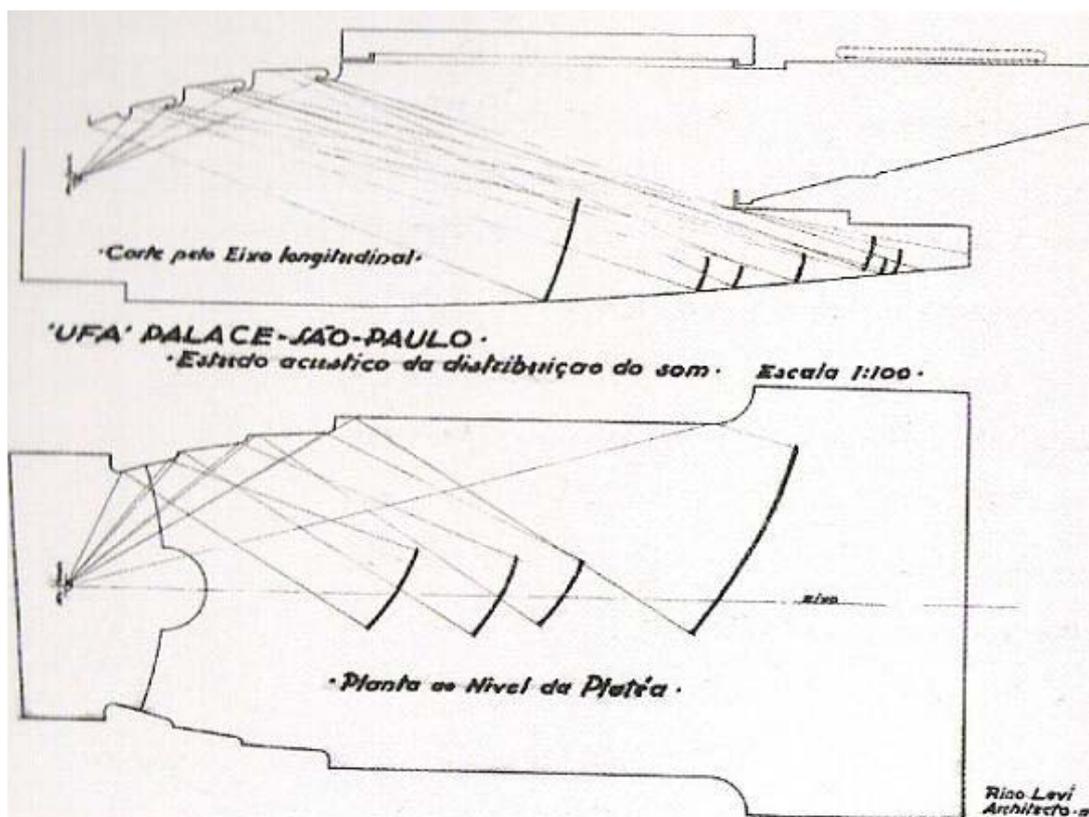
Estudo acústico de distribuição do som – Corte e planta
